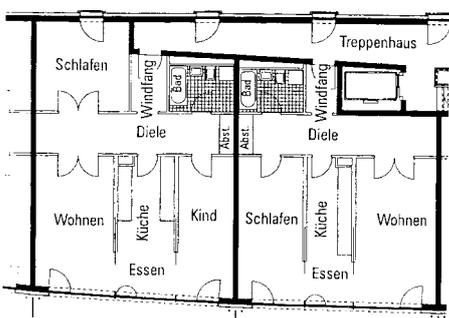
Grundriß 3- und 2-Zimmer-Wohnung
